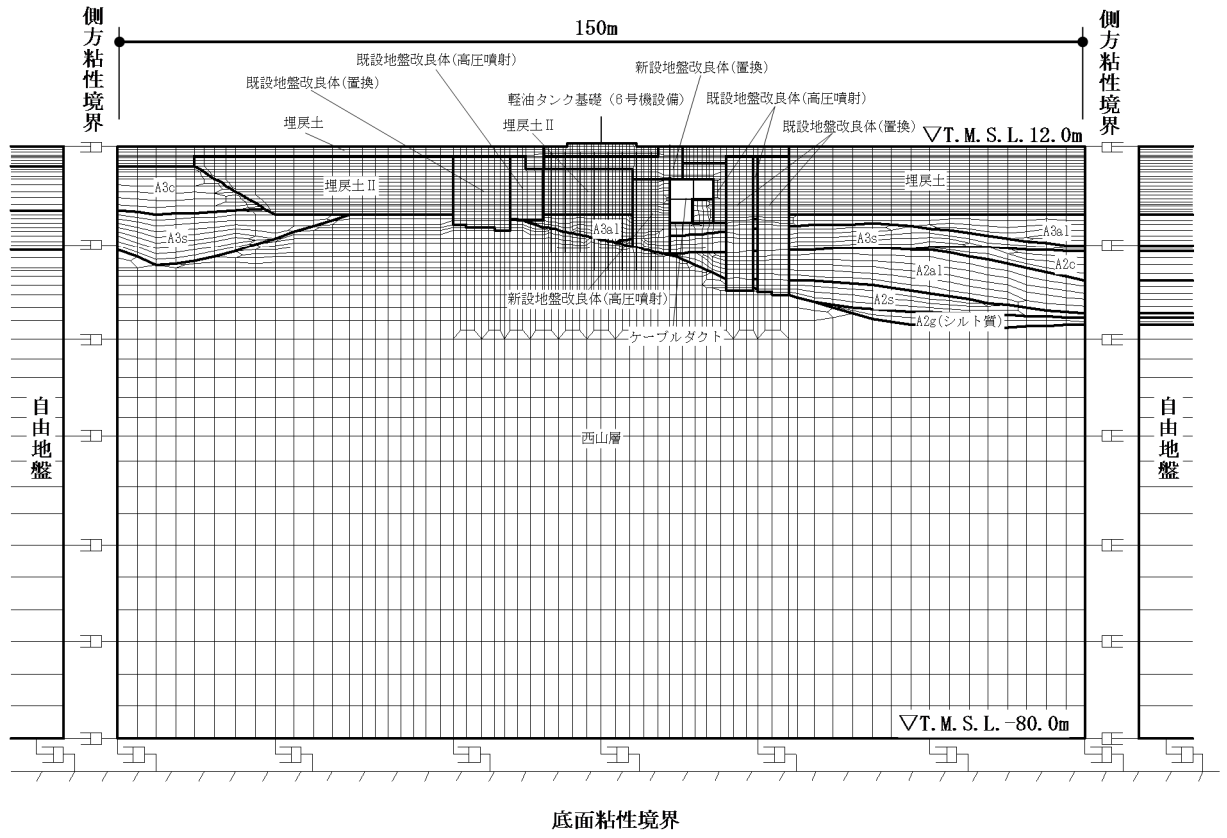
(1) 軽油タンク基礎 (6号機設備) 地震応答解析モデル (NS 断面)
